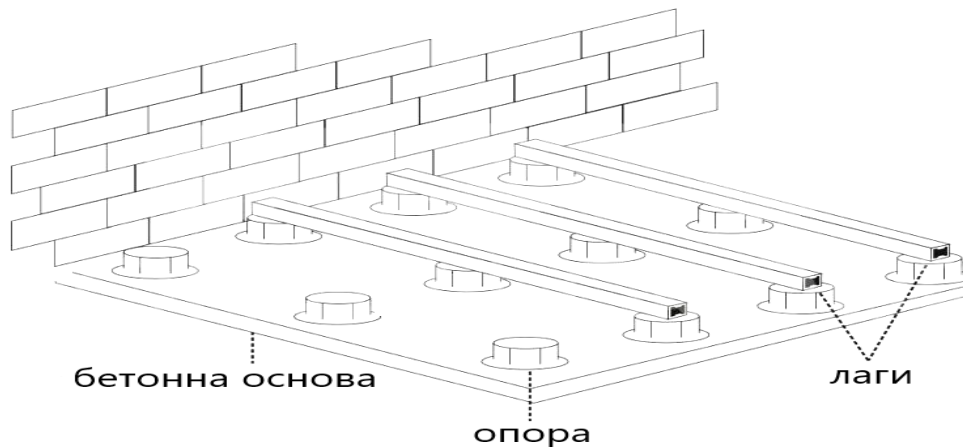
Схема монтажу опор на бетонній основі
